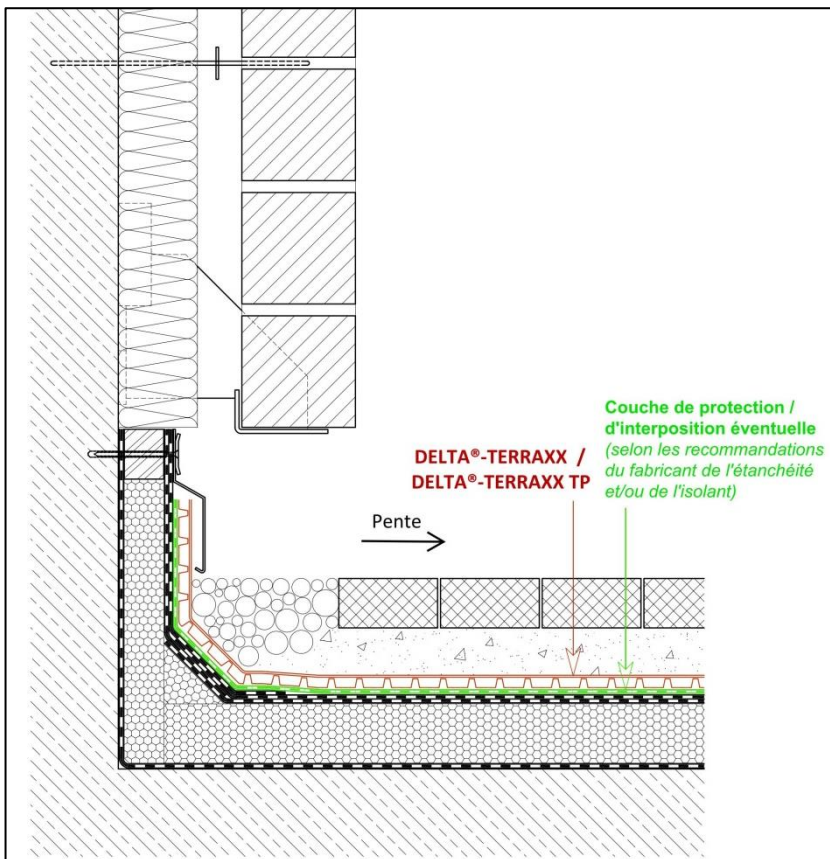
traitement des relevés en façade avec membrane d'étanchéité bitumeuse + DELTA®-TERRAXX / DELTA®-TERRAXX TP (protection lourde avec dalles ou pavés) – exemple 2
